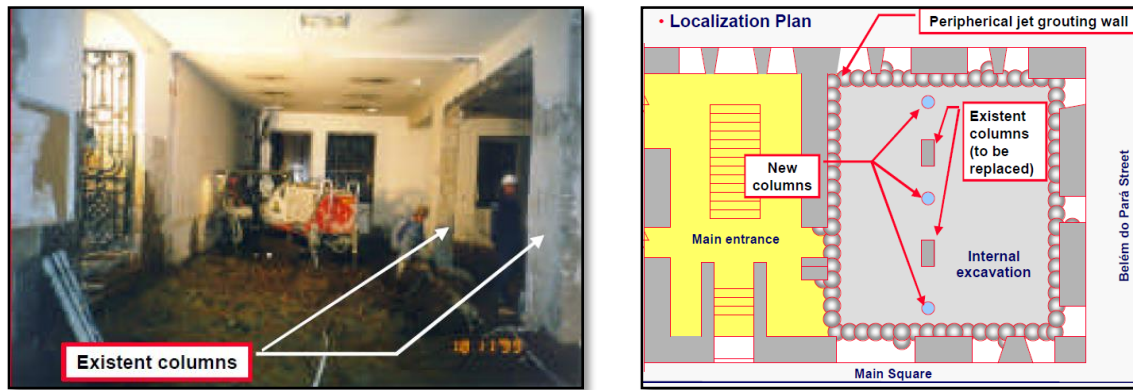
Trabajos de perforación dentro del edificio y plan de localización.
